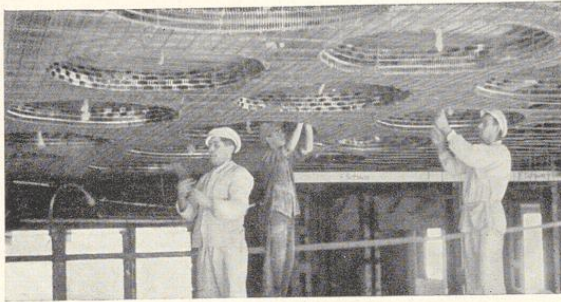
Rabitzdecke mit runden Vertiefungen für Beleuchtungskörper. Ausführung Stukkateurmeister E. Schwarz, Stuttgart-Hedelfingen
